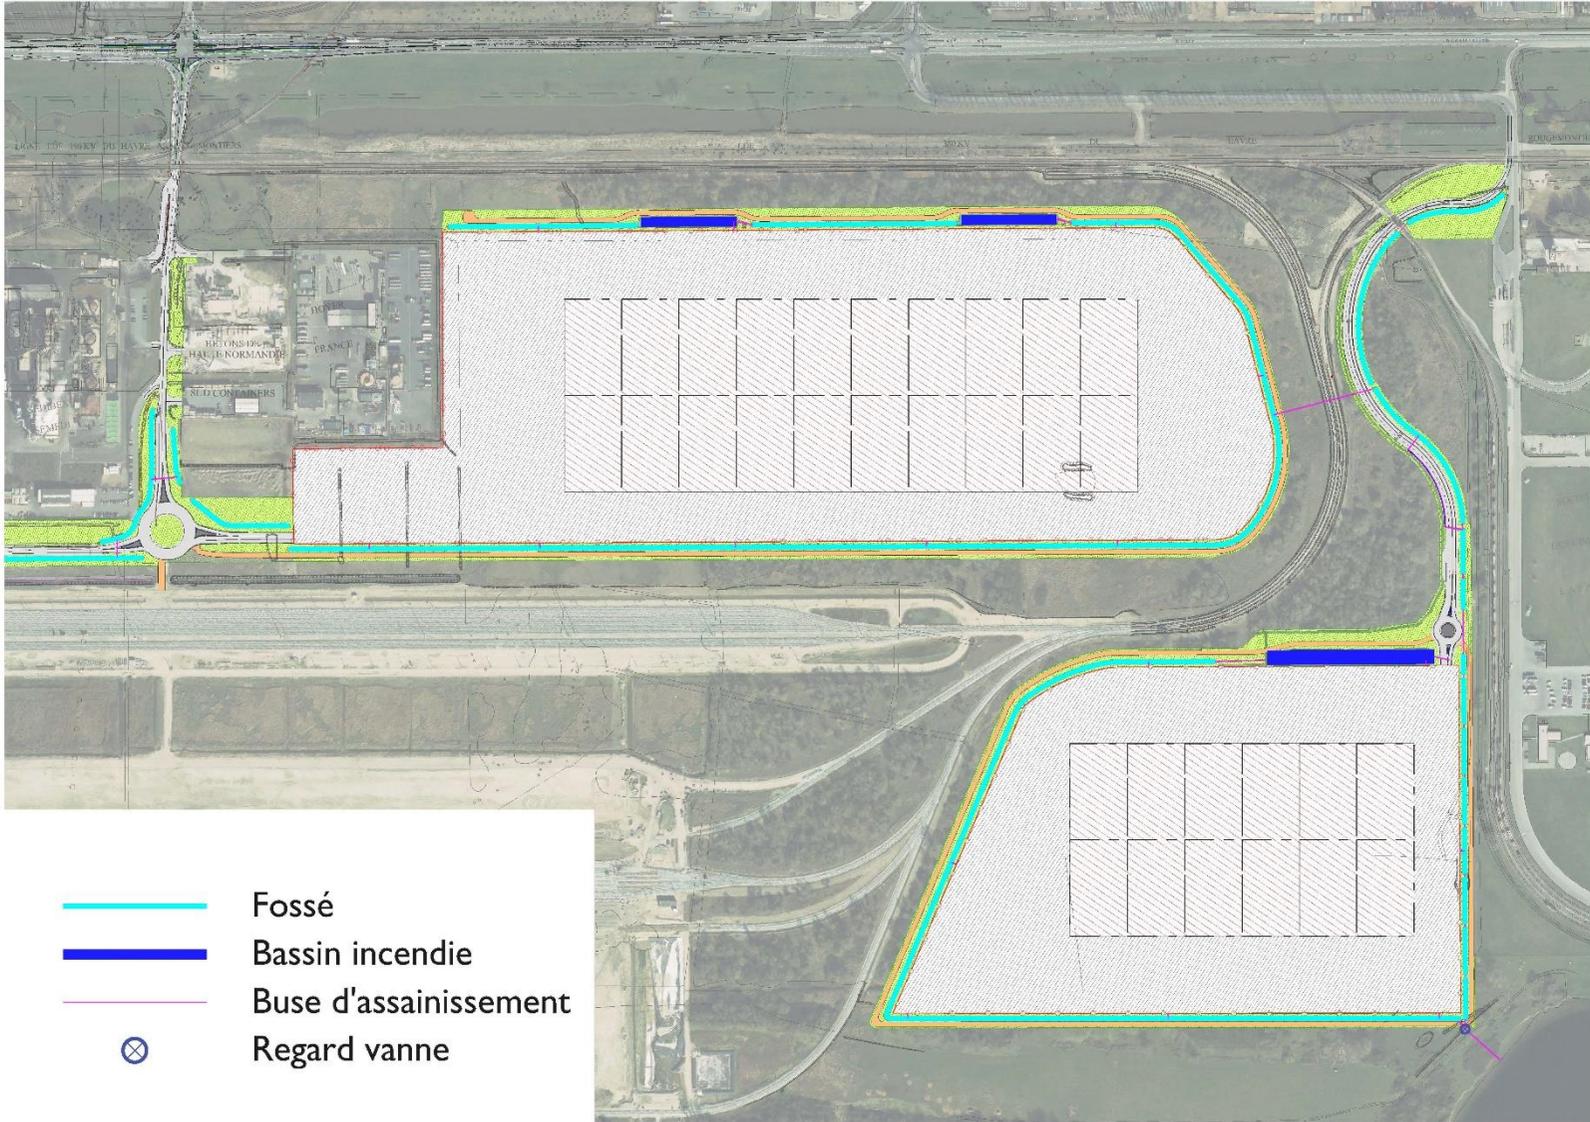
Figure XIII. Plan du réseau d'assainissement du projet PLPN3
